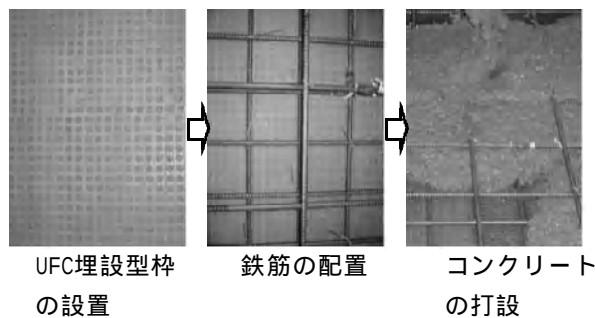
UFC埋設型枠RC床版供試体の施工手順
